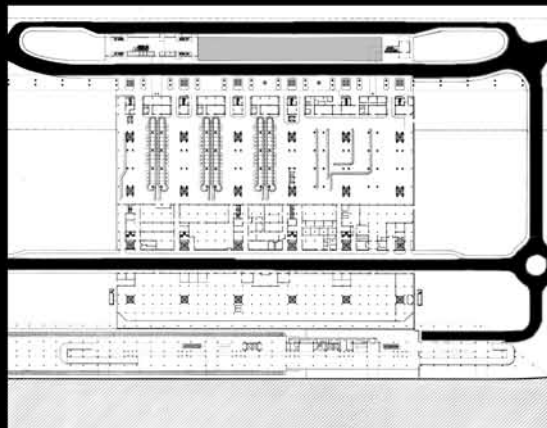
Planta primer nivel aeropuerto Stansted
